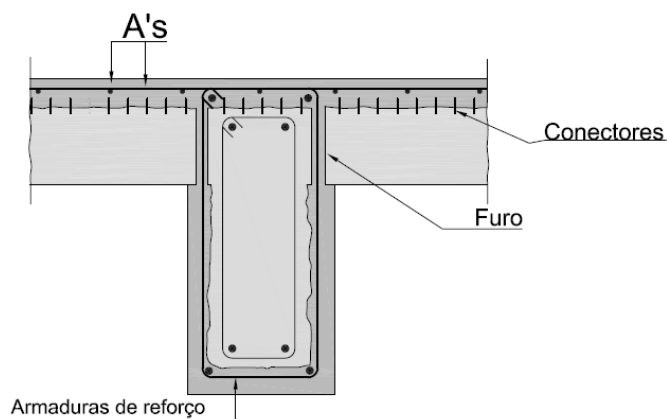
Reforço de vigas ao corte e à flexão, adaptado de [12].
